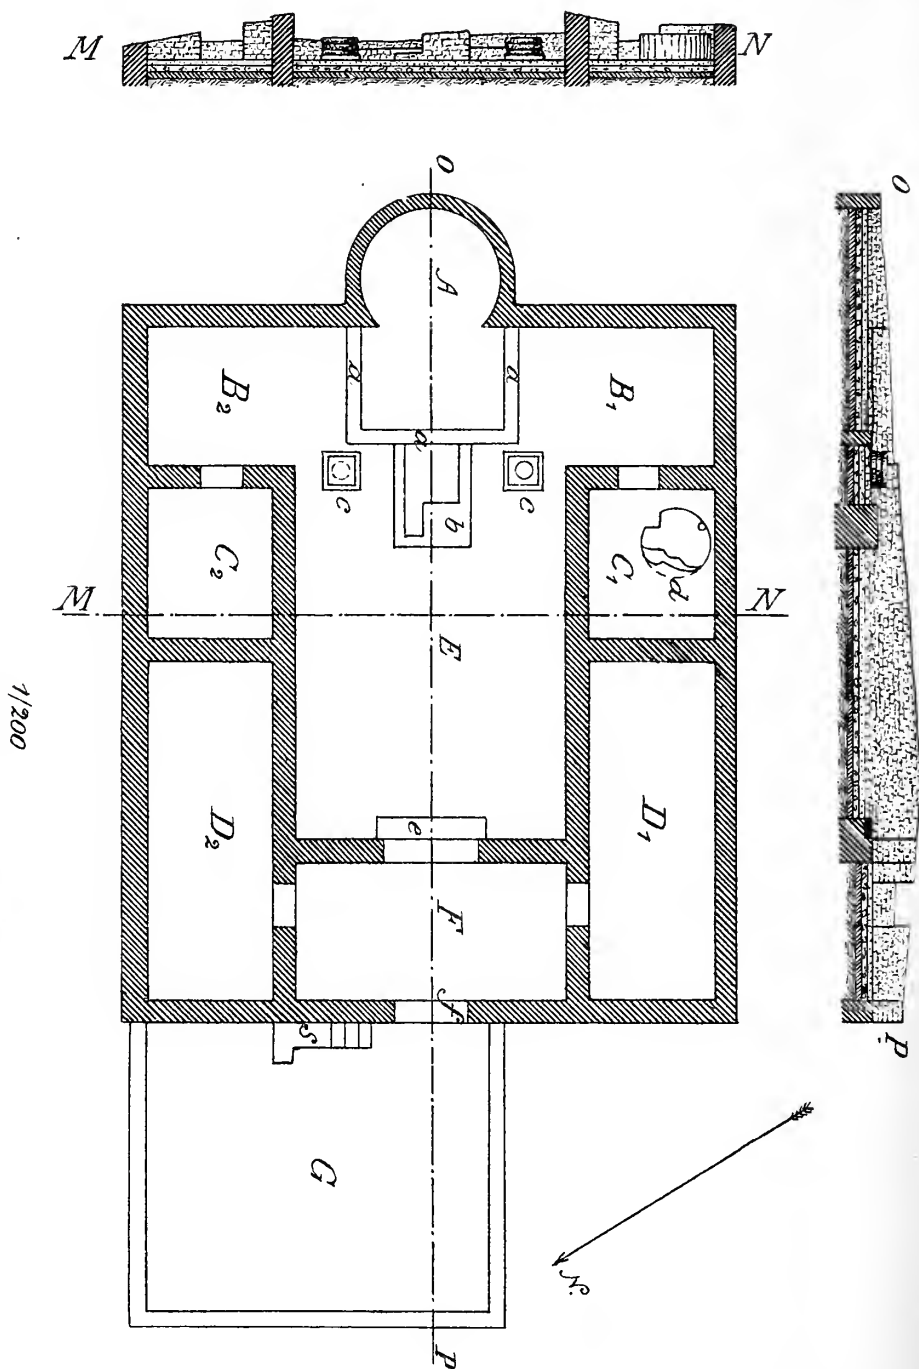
Grundriss eines römischen Gebäudes in Mainz.
